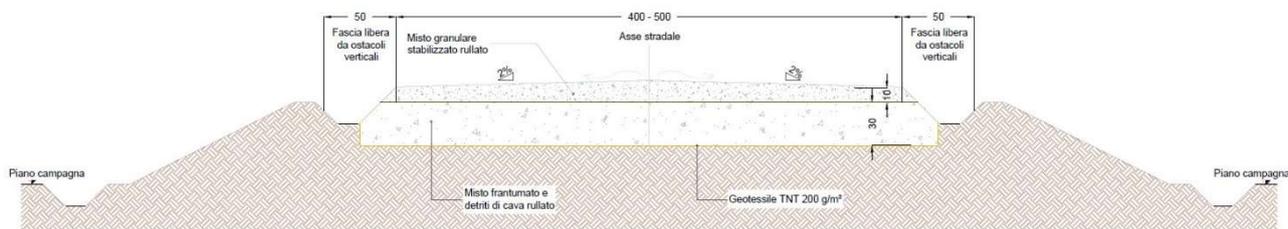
Sezione tipo pista di impianto su rilevato; misure in centimetri
